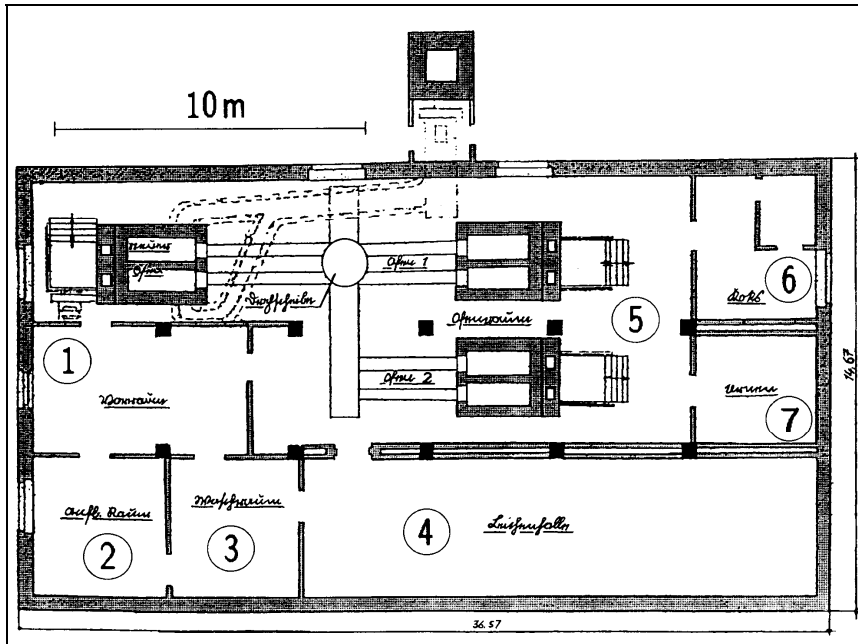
Grundriss des Krematoriums I im Lager Auschwitz
